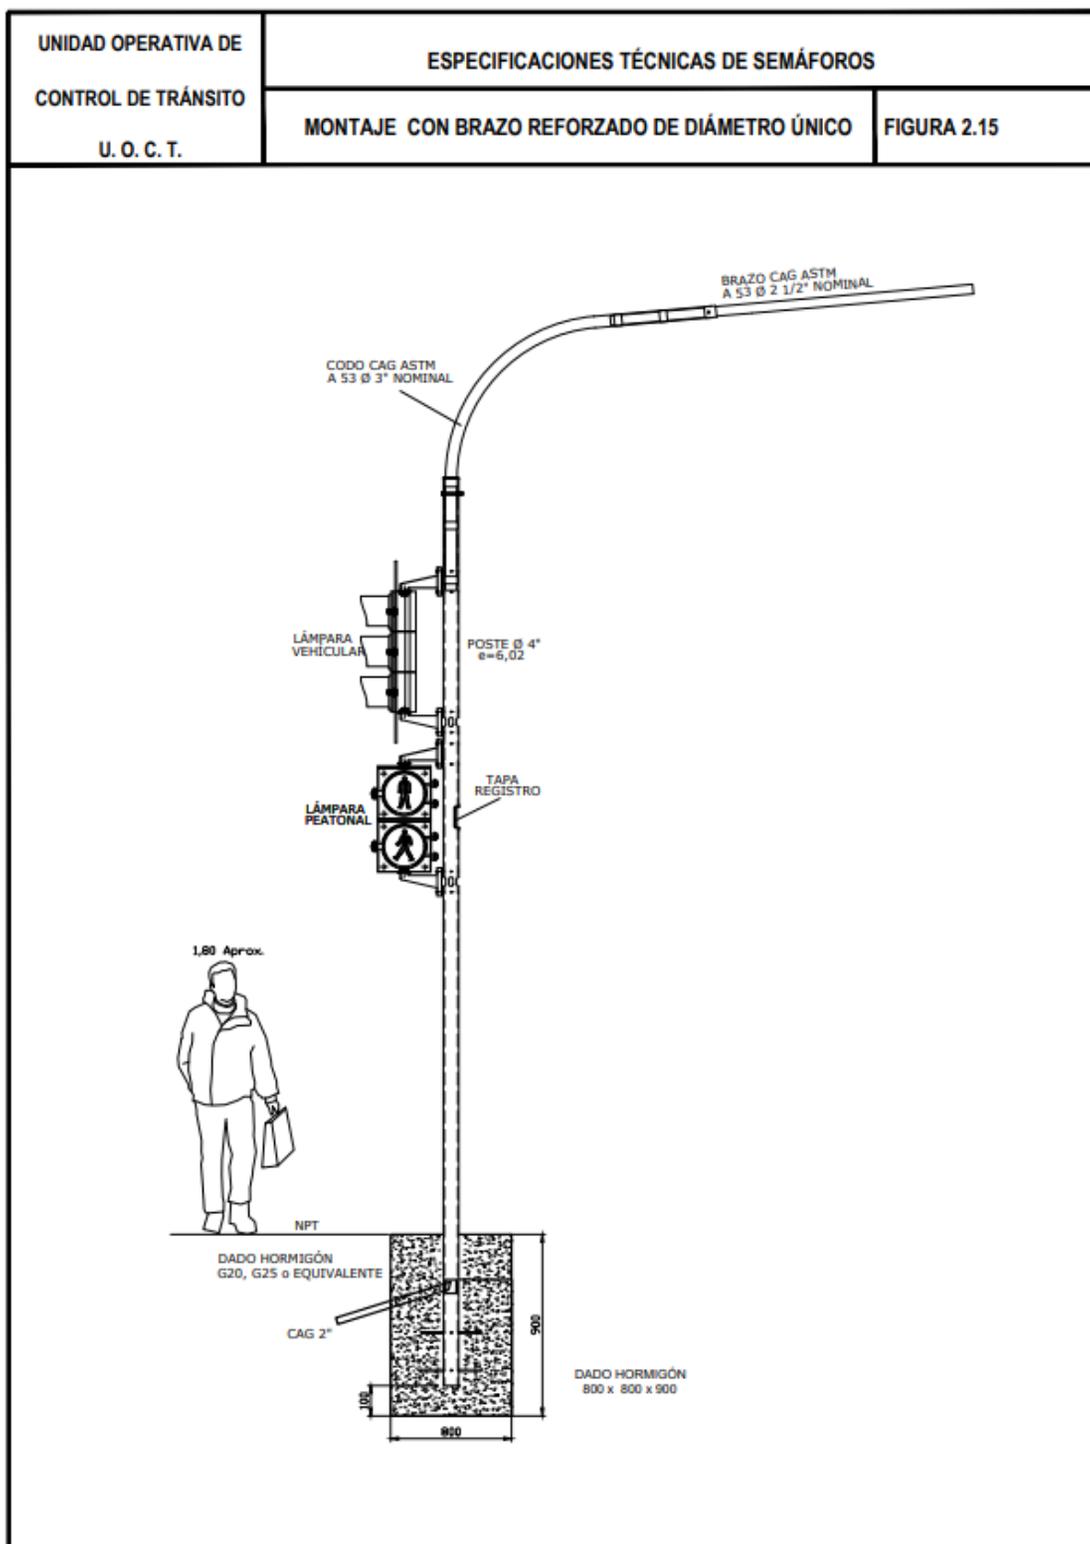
15 Montaje con brazo reforzado de diámetro único
